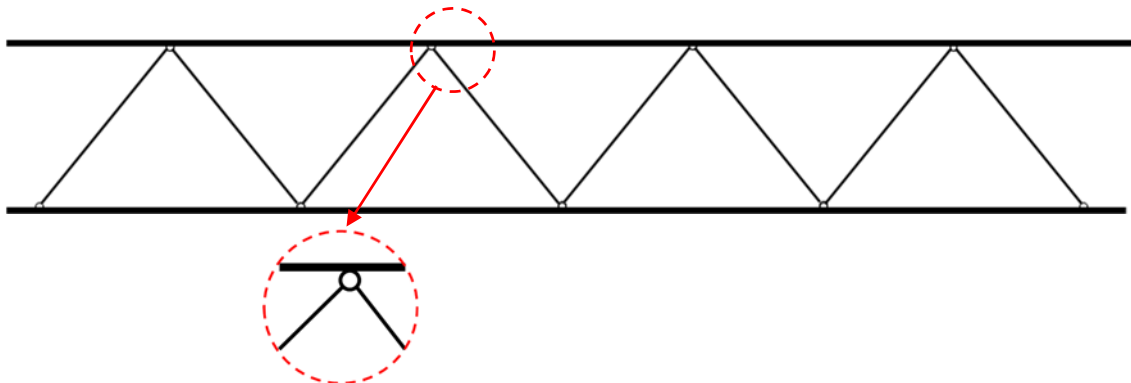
Diagonales de reticulado articuladas y cordón continuo
